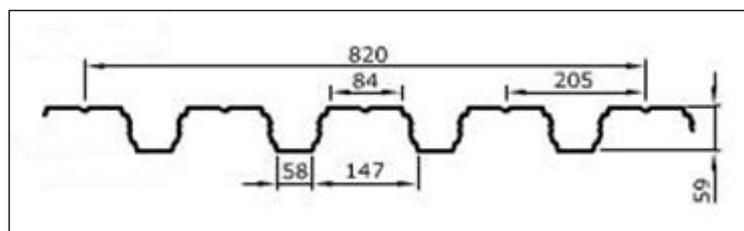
Geometria da chapa de aço galvanizado perfilada trapezoidal testada.
